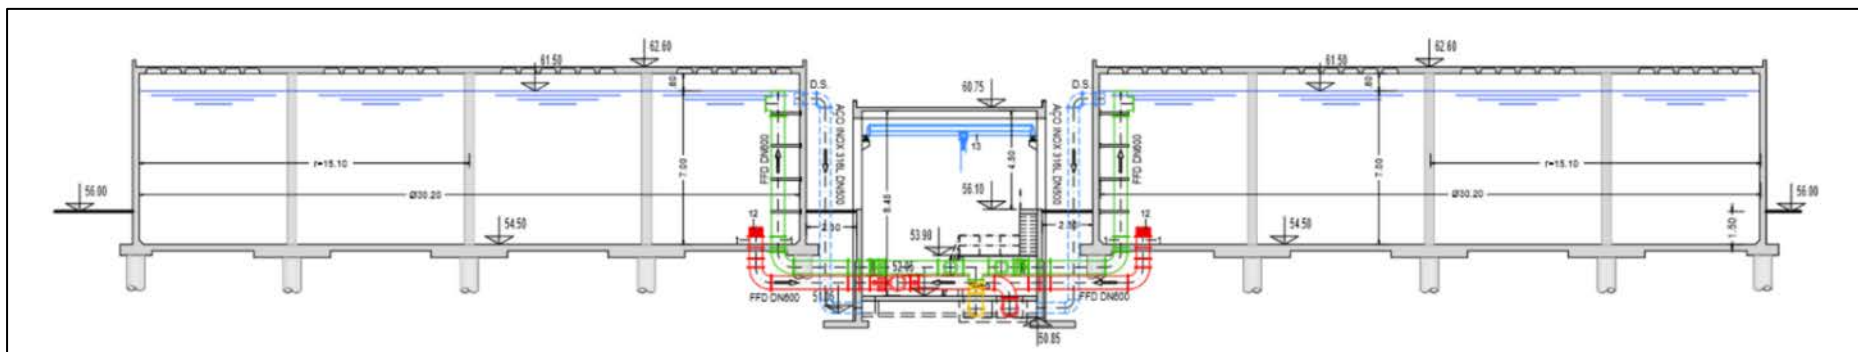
Secção transversal das câmaras de armazenamento do reservatório (Fonte: CCA, 2026)
